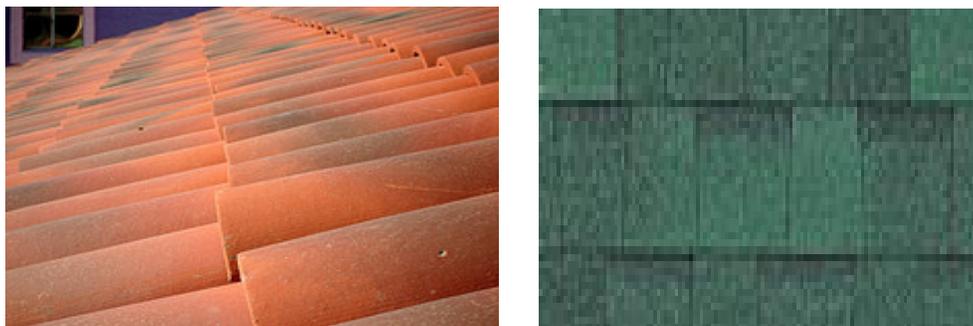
Cubierta de teja de barro y loseta asfáltica.
